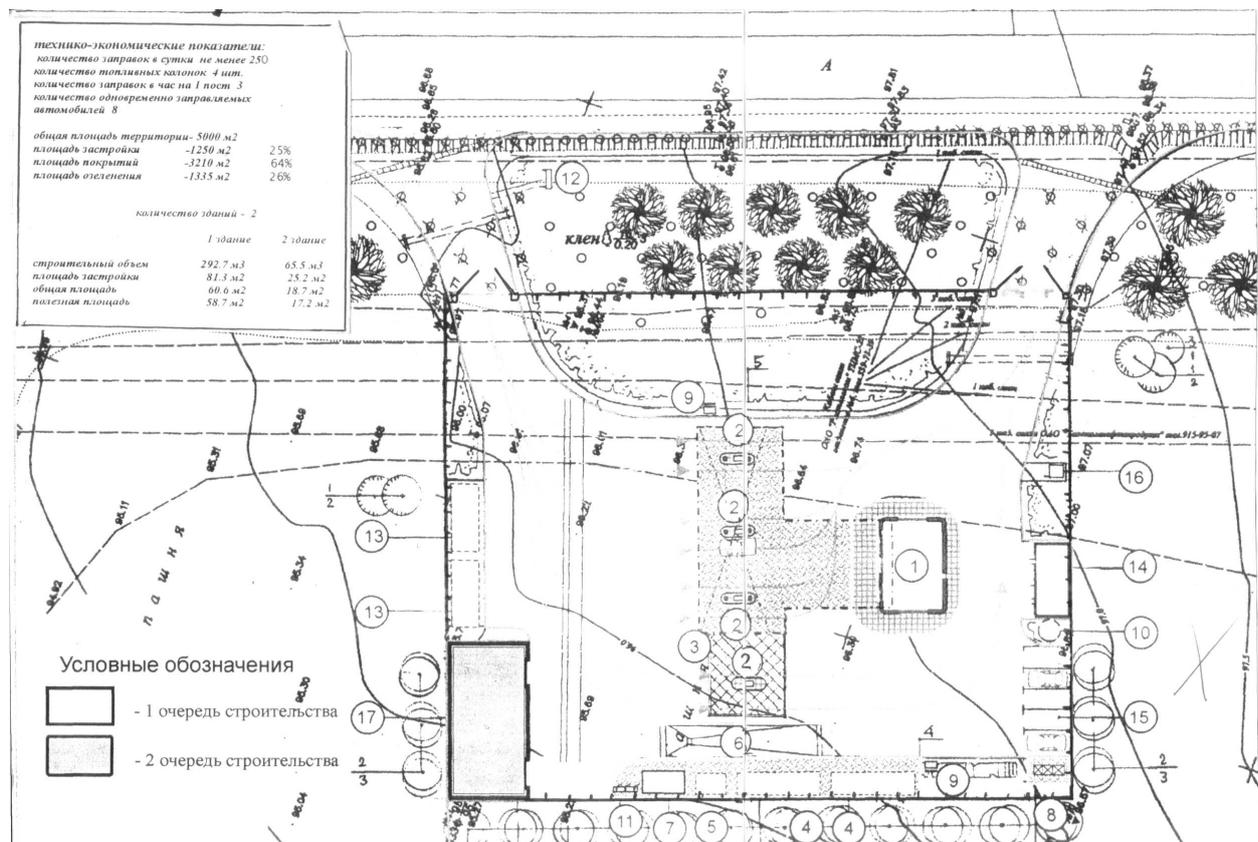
Генеральный план автозаправочной станции : 1 – операторная ; 2 – заправочный островок ; 3 – навес ; 4 – резервуар для топлива ; 5 – аварийный резервуар ; 6 – площадка слива топлива ; 7 – очистительные сооружения ; 8 – контейнеры для твердых отходов ; 9 – пожарный щит ; 10 – туалет для клиен-
